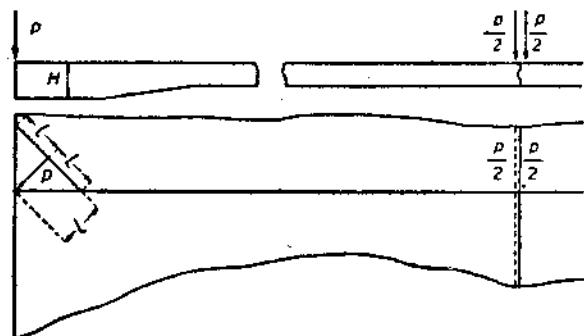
Схема бетонной плиты при расчете „по Ольдеру“.
